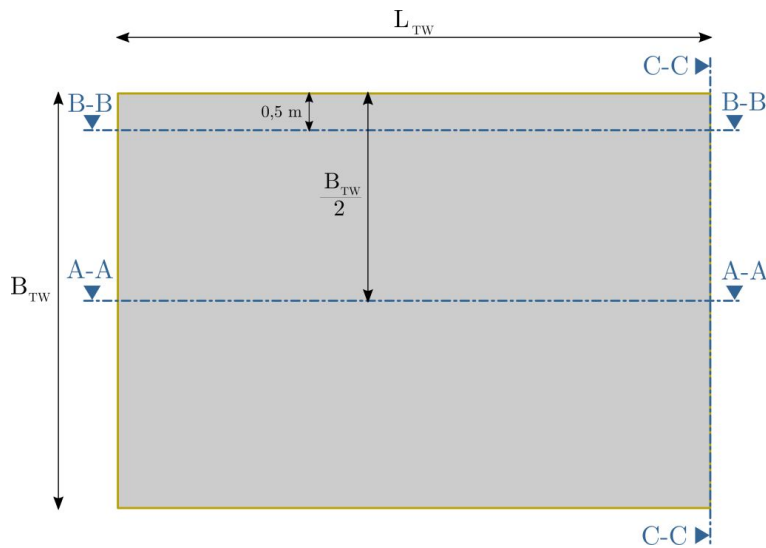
Skizze Grundriss Überbauplatte für Auswertung der Schnittkräfte
